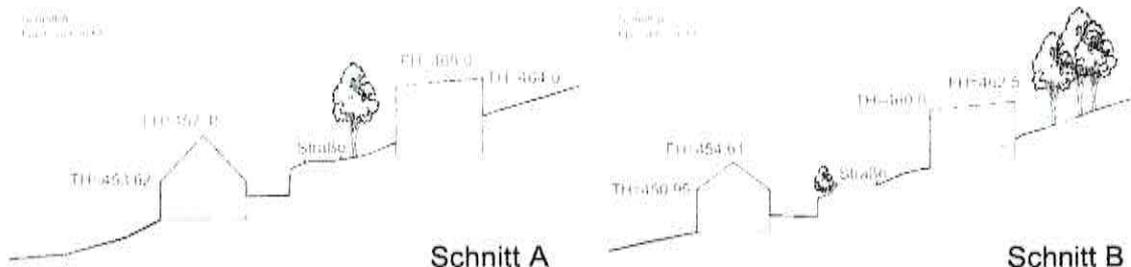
Schematische Darstellung einer möglichen Bebauung mit einem flach geneigten Dach (eigene Darstellung)
